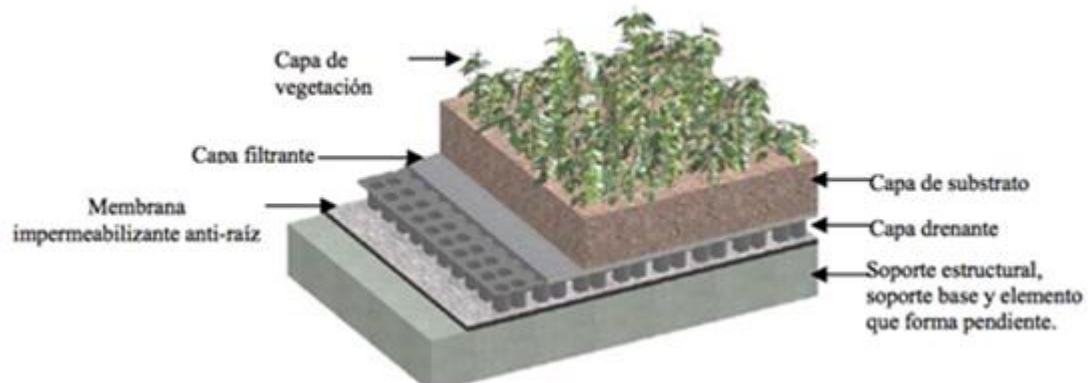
Sección cubierta verde www.ordenjuridico.gob.mx
